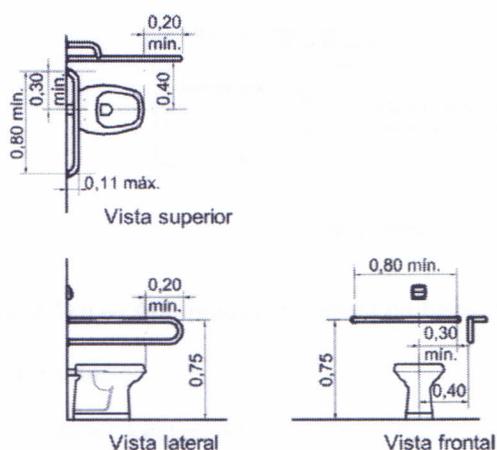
Bacia sanitária – Exemplo de barra de apoio lateral com fixação na parede de fundo
